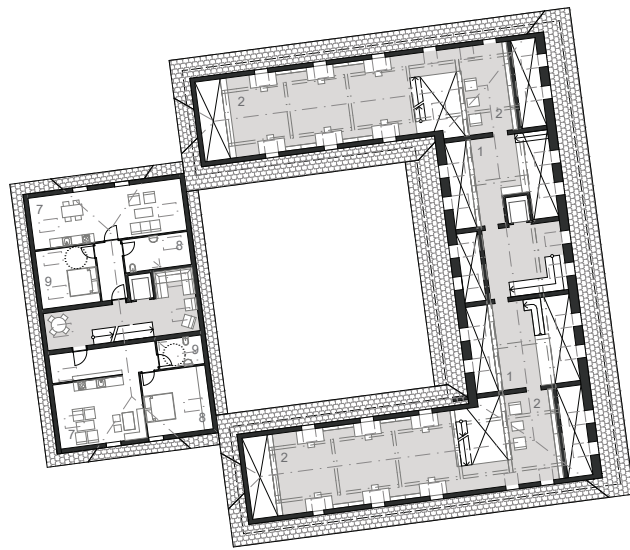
Grundriss Obergeschoss - M 1:500 bzw. 1:200
